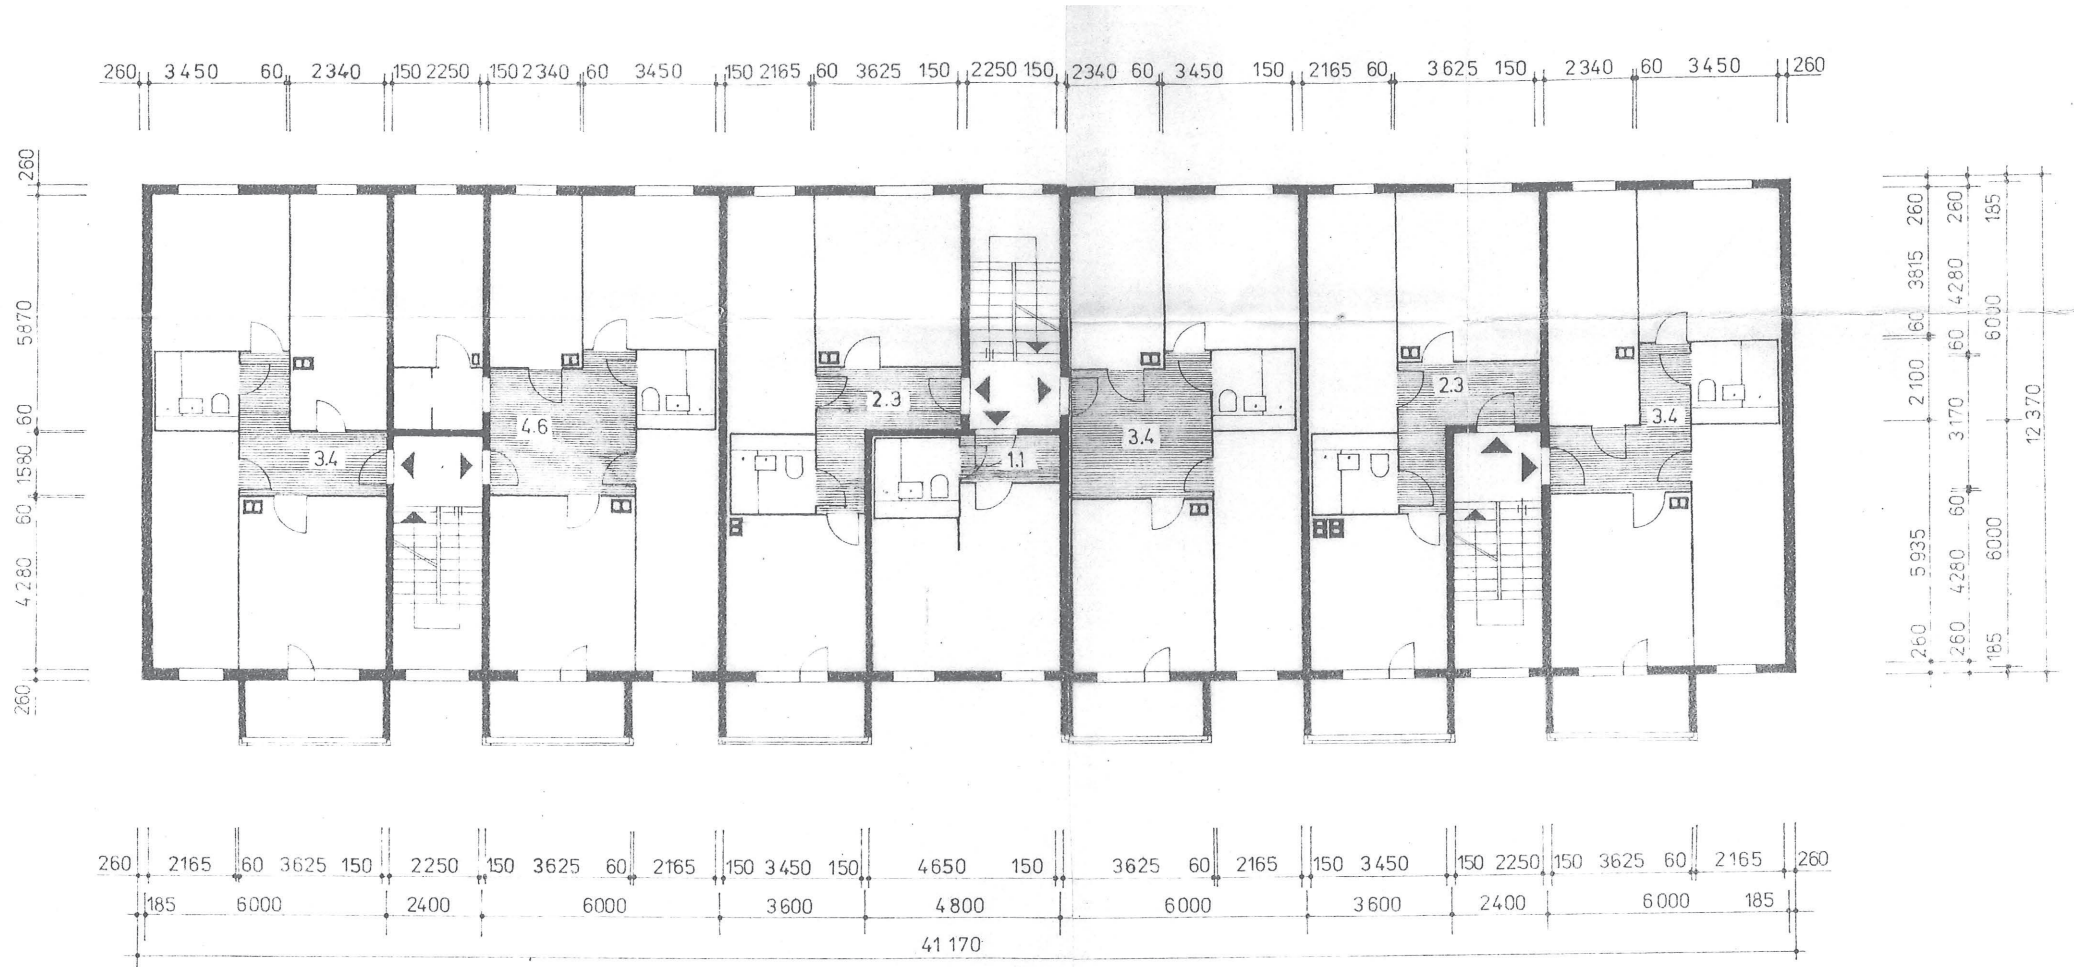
Grundriss Regelgeschoss WBS 70
